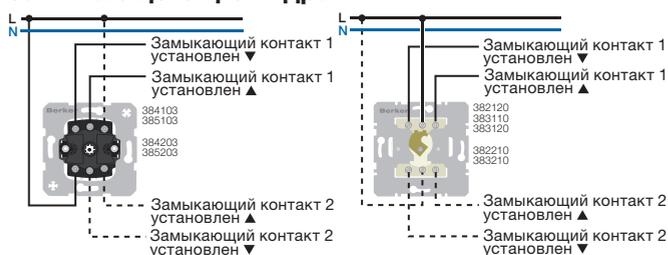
Жалюзиный поворотный выключатель 1- и 2-полюсный [№ для заказа 3841 03, 3842 03]; выключатель жалюзи 1- и 2-полюсный для центральной панели с замком [№ для заказа 3851 03, 3852 03] / выключатель/кнопка жалюзи 1- и 2-полюсный для профильных полуцилиндров [№ для заказа 382..., 383..]
